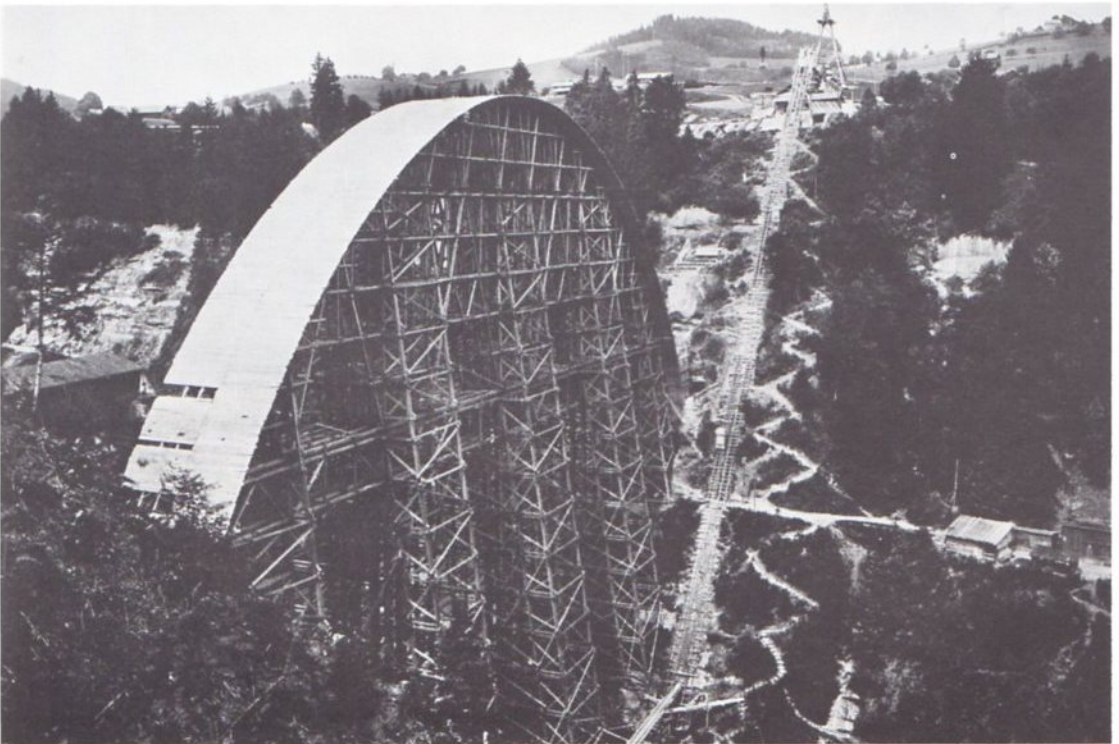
Lehrgerüst der Hundevilertobelbrücke in der Schweiz. Für die aufzubringenden Betonmassen und Stahleinlagen ist eine sehr aufwendige statische Konstruktion in Fachwerkausbildung notwendig.
